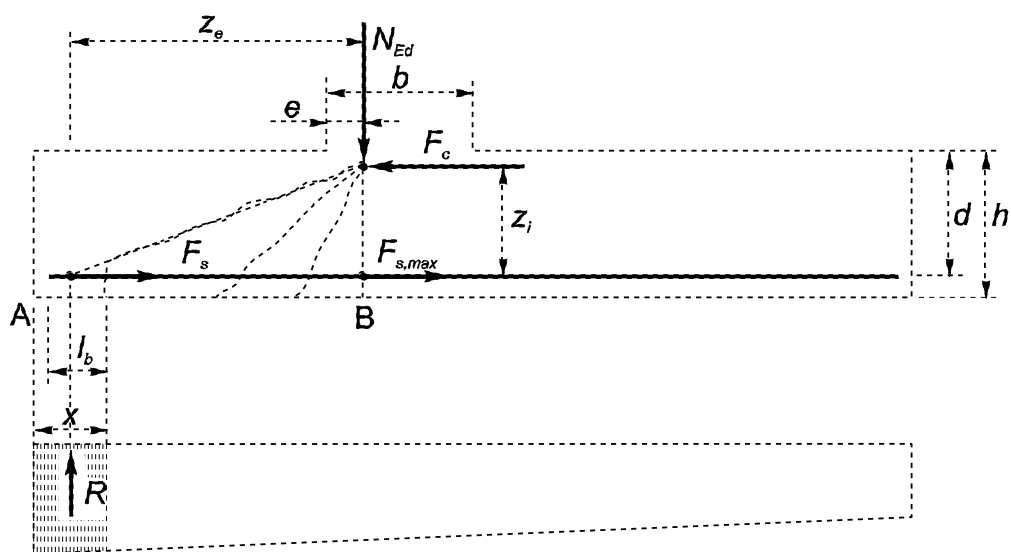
Модель растягивающего усилия с учетом наклонных трещин
